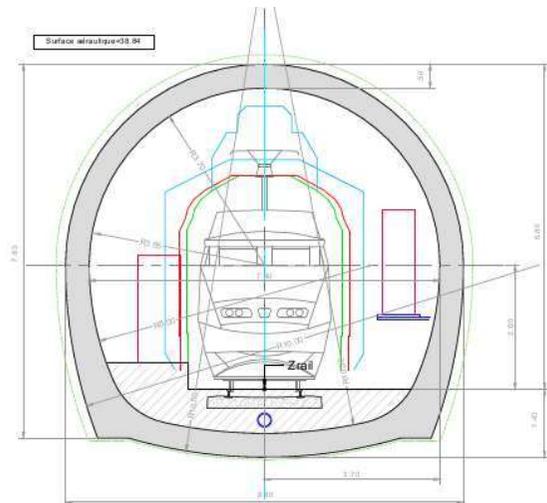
Profil en travers type du tunnel (EGIS, 2021)
